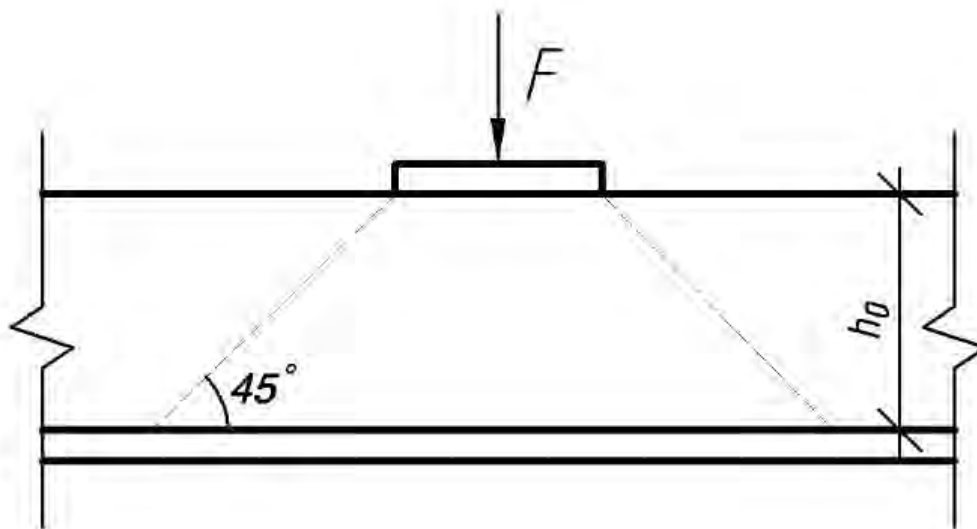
Схема расчета железобетонных элементов на продавливание по [11]
